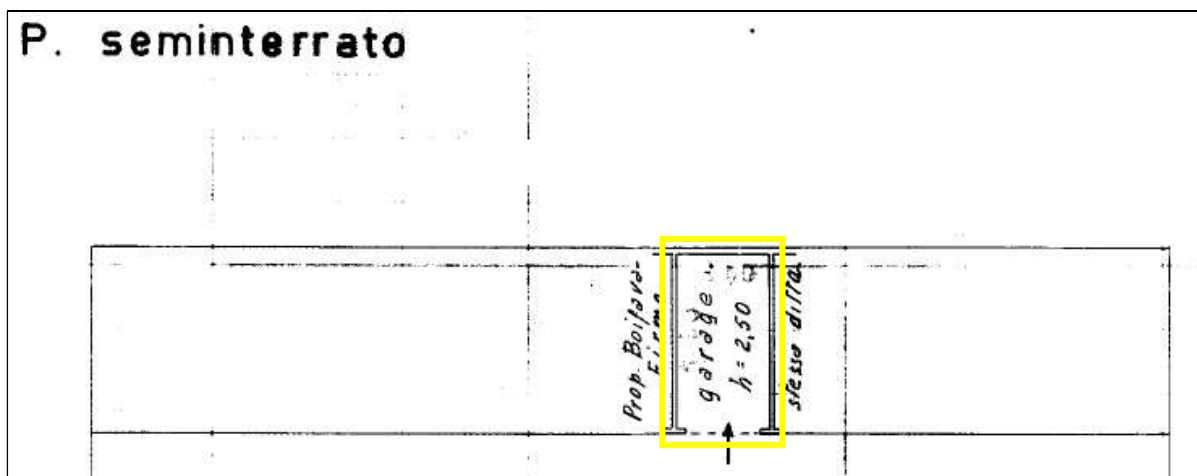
Estratto planimetria – Sez. SNA fg.6 Part. 4095 sub 4
